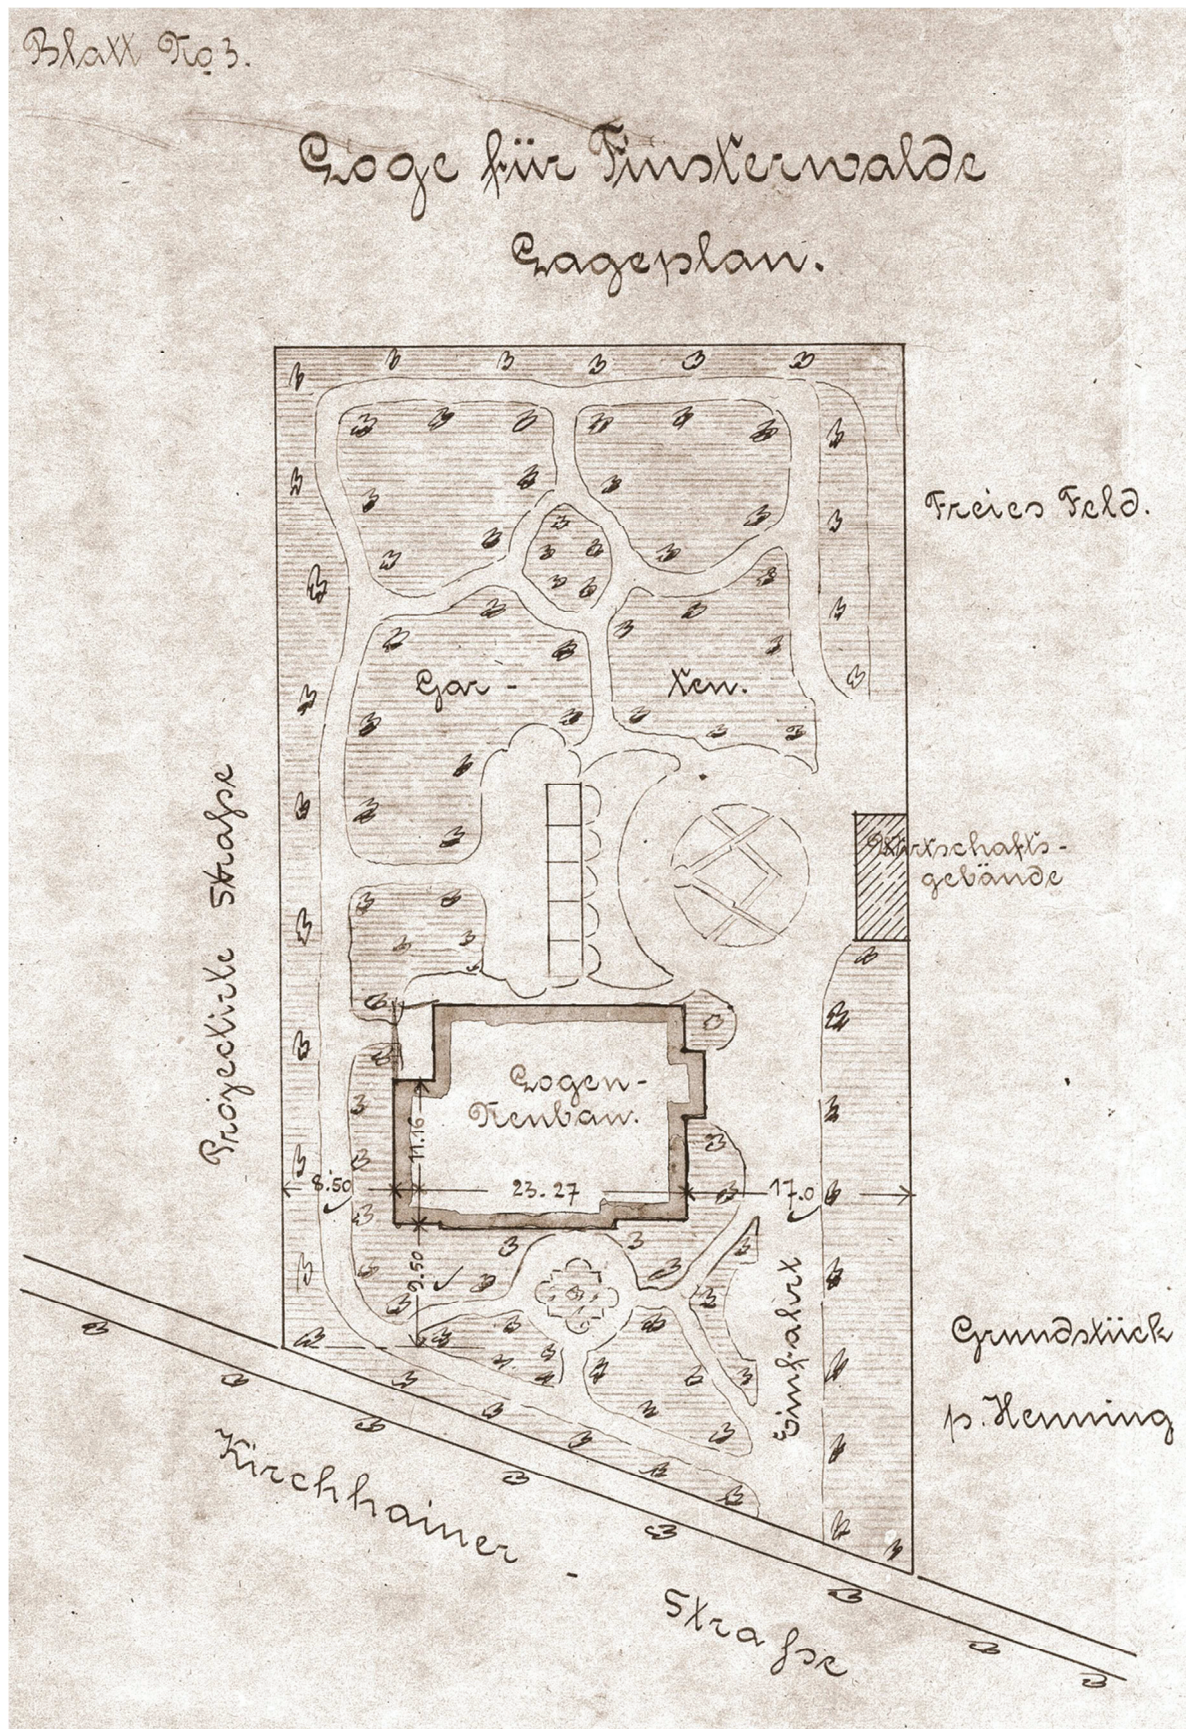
Lageplan vom 24.04.1903 original Maßstab 1:500 (o.M.)
